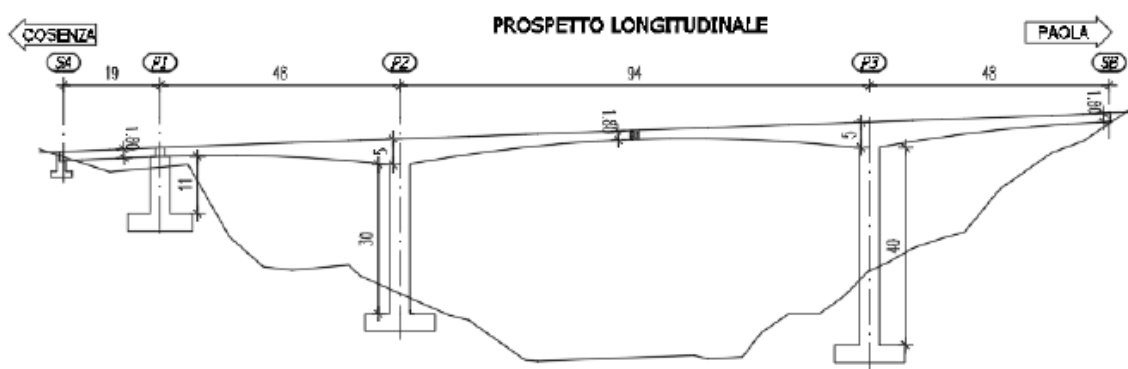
Prospetto longitudinale del viadotto Emoli 2 -Stato di fatto (Fonte: Lista di Controllo).
